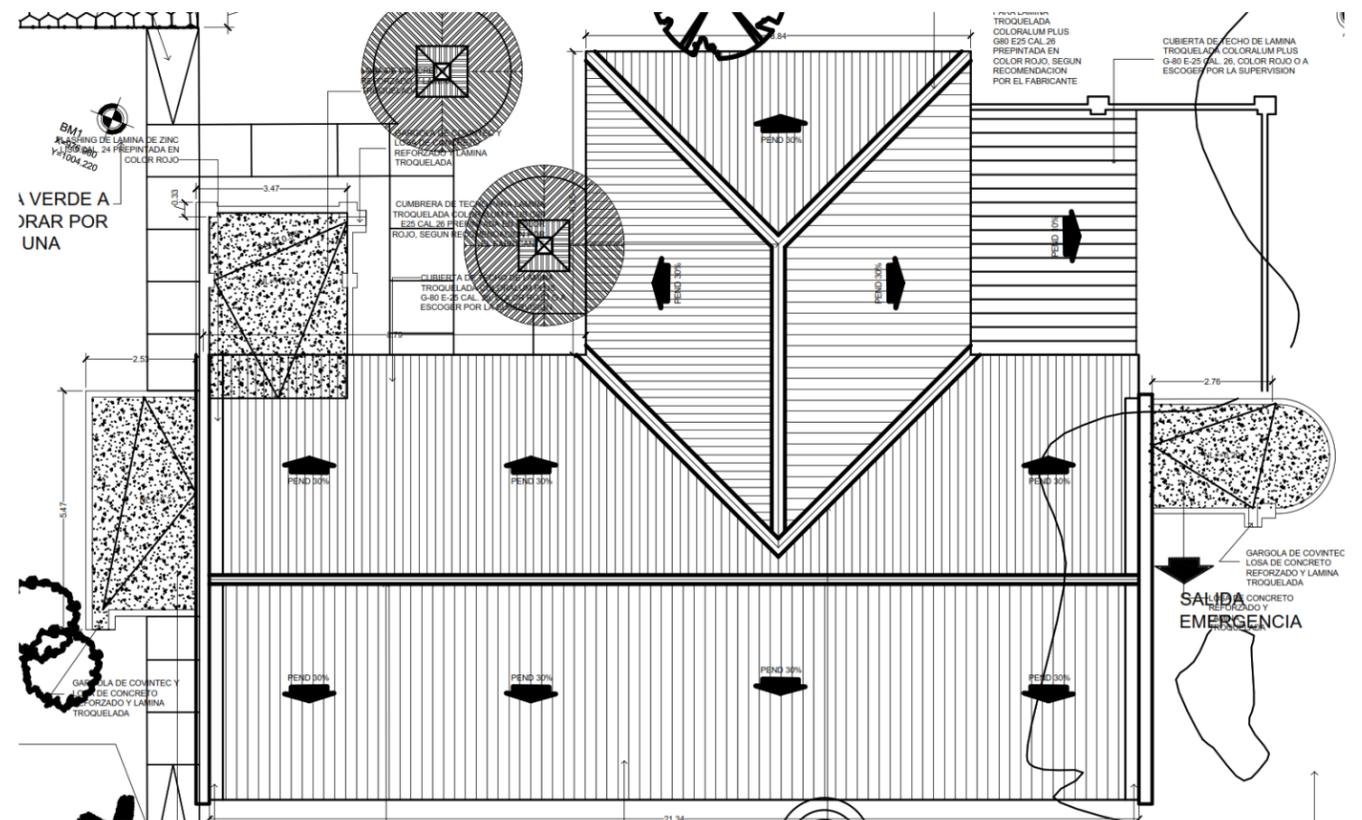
Cubierta de techo. Diagrama de cubierta de techo.
